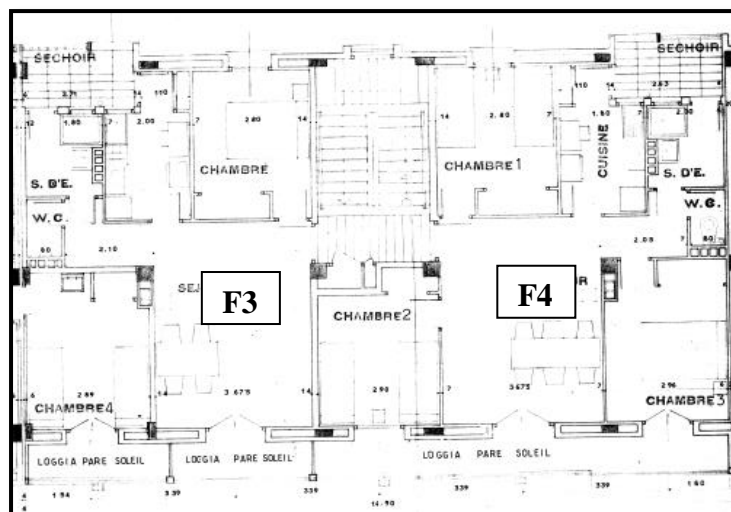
Plan d'un étage du quartier HLM de type de logements F3 et F4
